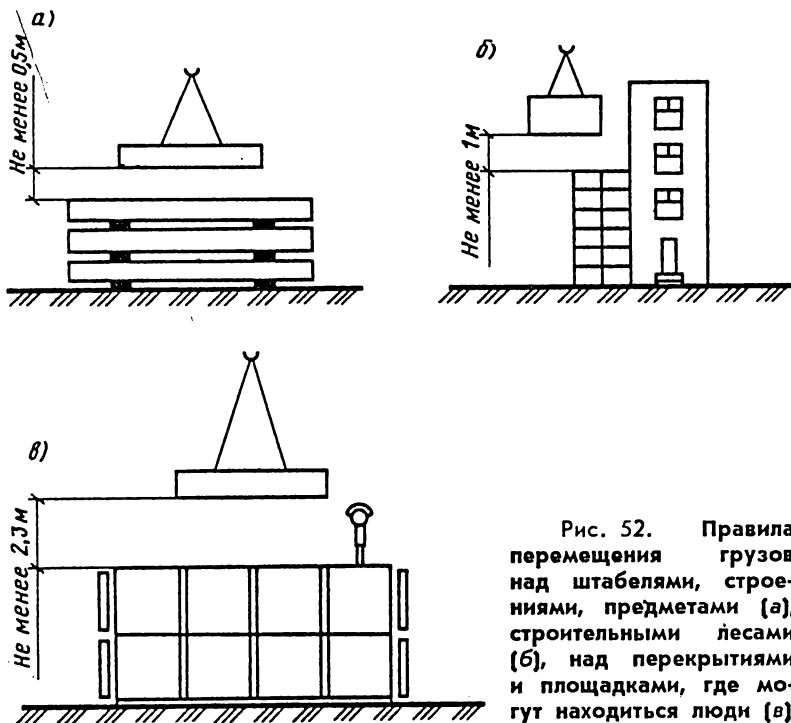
Правила перемещения грузов над штабелями, строениями, предметами (а), строительными лесами (б), над перекрытиями и площадками, где могут находиться люди (в)
